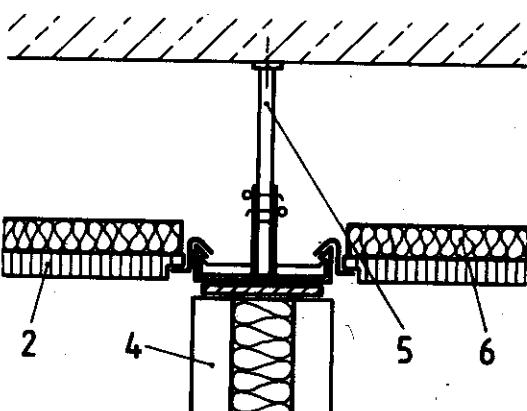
Unterdecke mit Bandprofilen und Leichtspan-Schallschluckplatten in Einlegemontage
